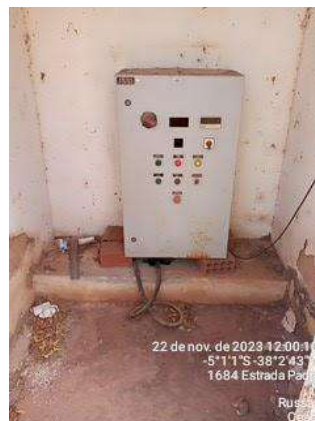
Captação - EEPT-03 (Jardim de São José): quadro de comando sobre tijolos, infraestrutura deteriorada.
